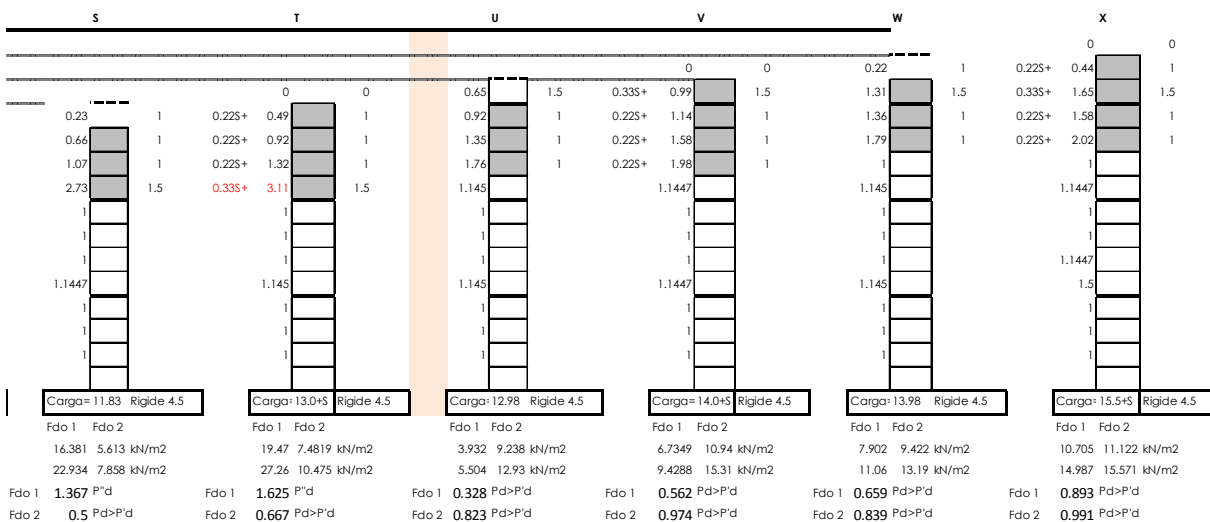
Proceso Constructivo. \$ cimbras 3 forjados de sacrificio. Losa Maciza. 4/5
